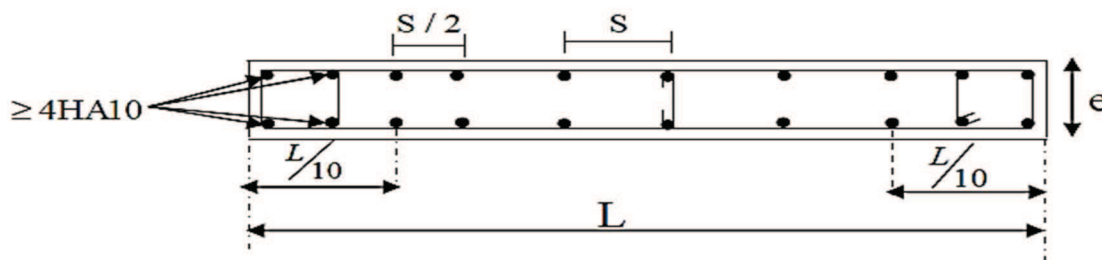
Disposition des armatures verticales dans les voiles.
